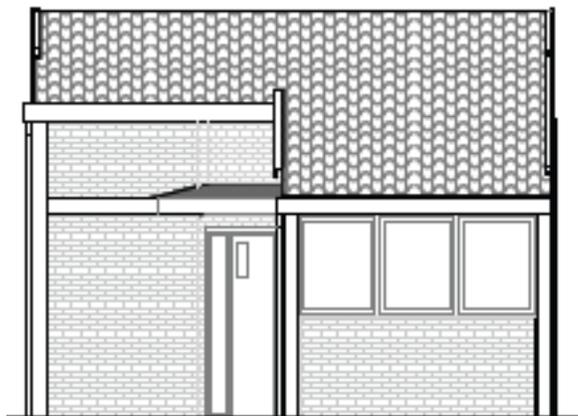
Fachada arquitectónica vivienda tipo 1 urbanización "Los Nogales".
